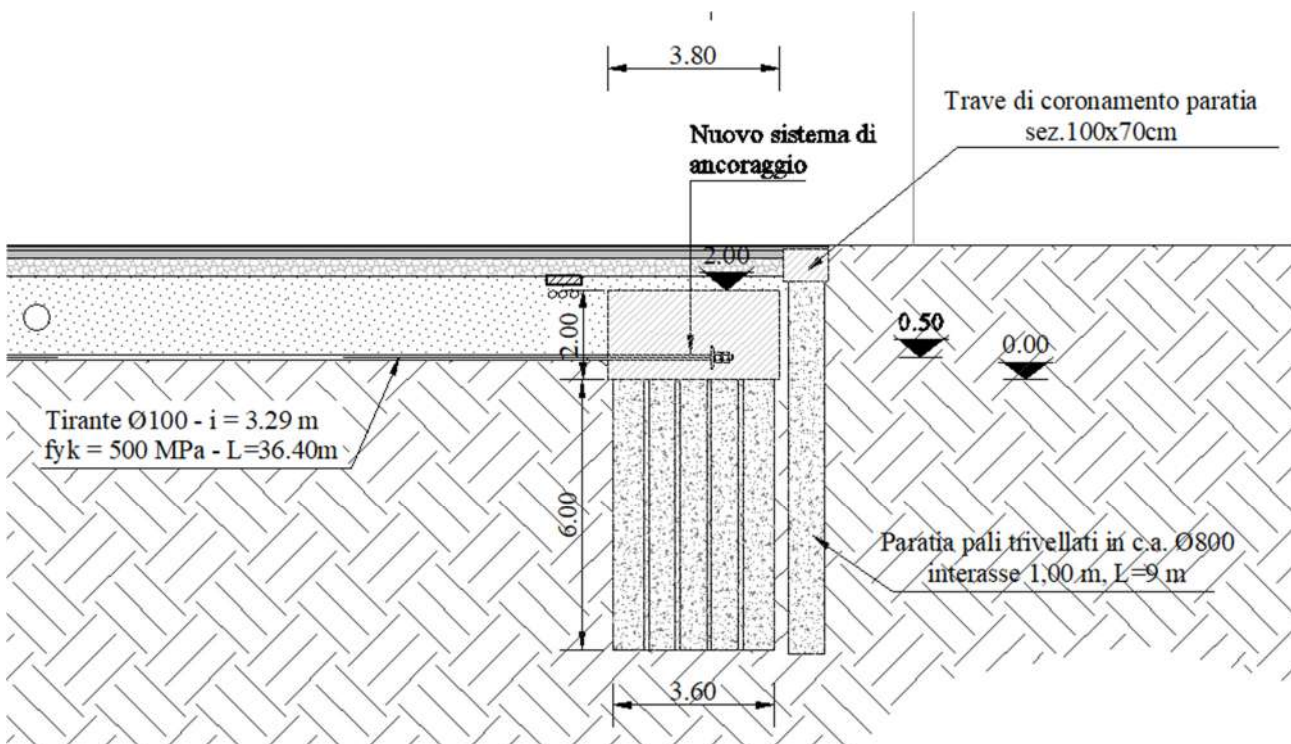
Schema del sistema strutturale di ancoraggio nella zona del capannone
